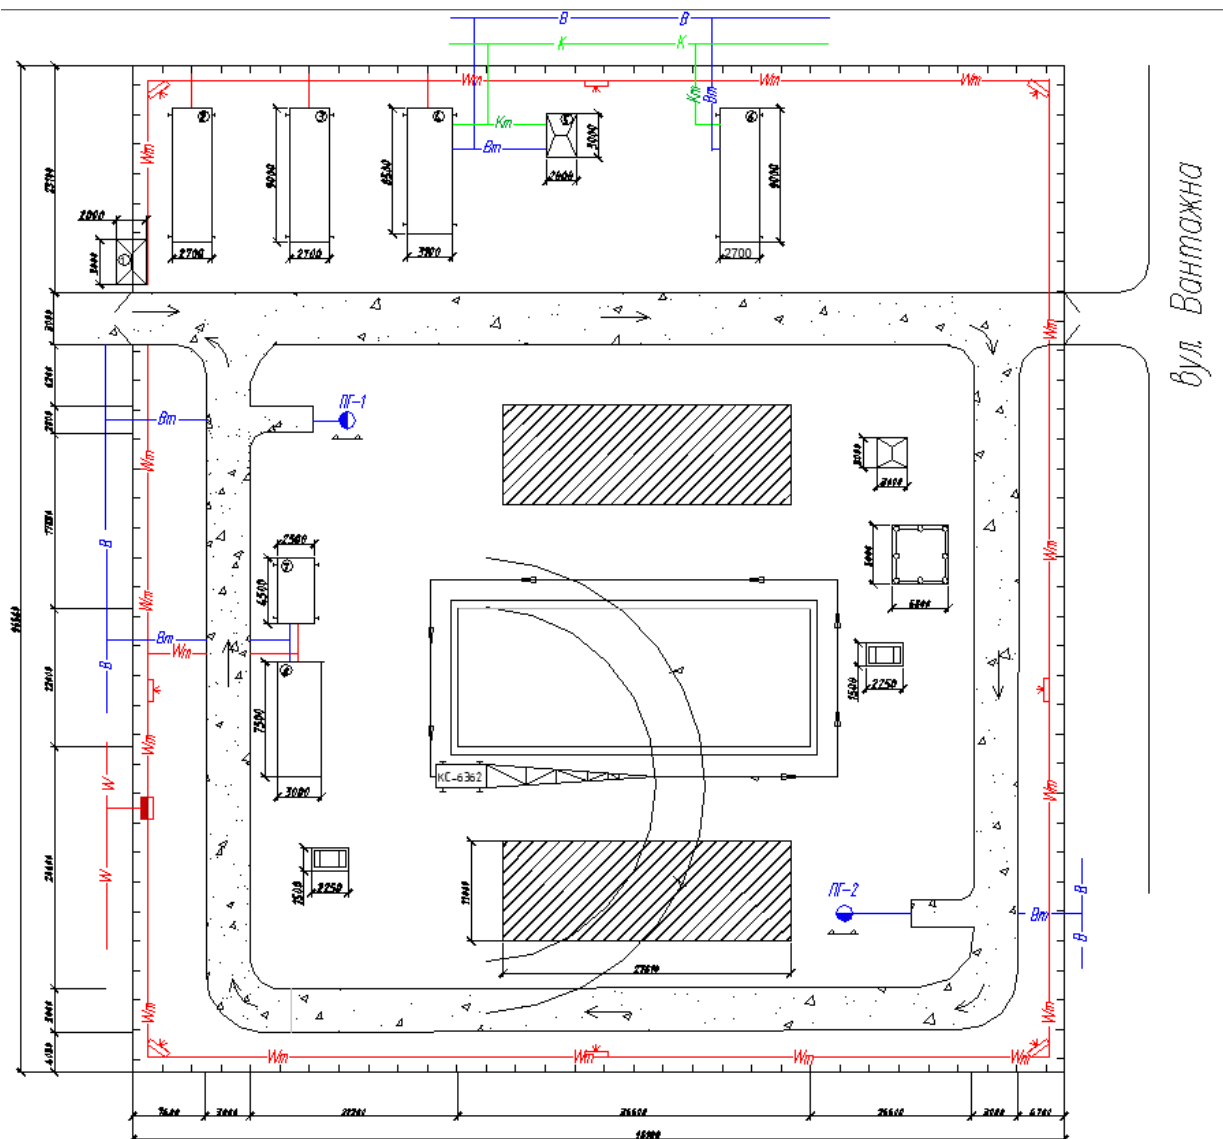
Схема генерального плану будівельного майданчику
